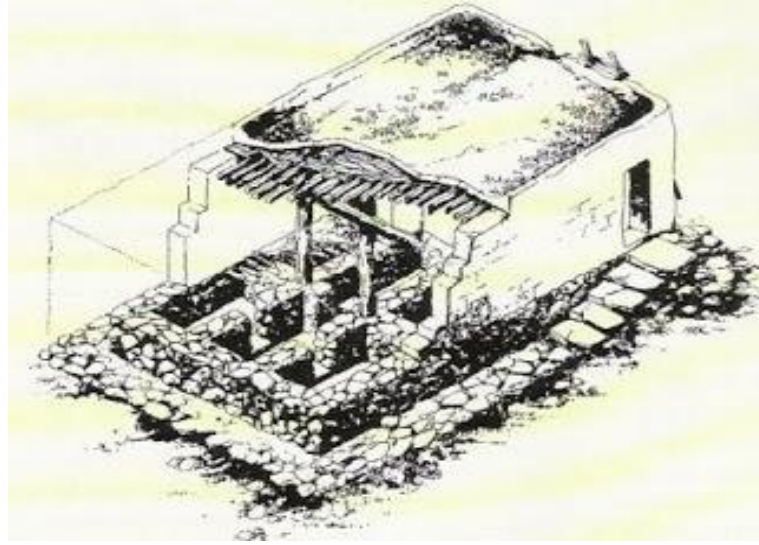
Çayönü Izgara Planlı Yapı Temelleri.
